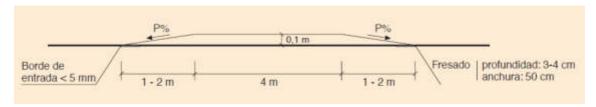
Paso peatones sobreelevado. Fuente: ORDEN FOM 3053/2008 de 23 de septiembre.
